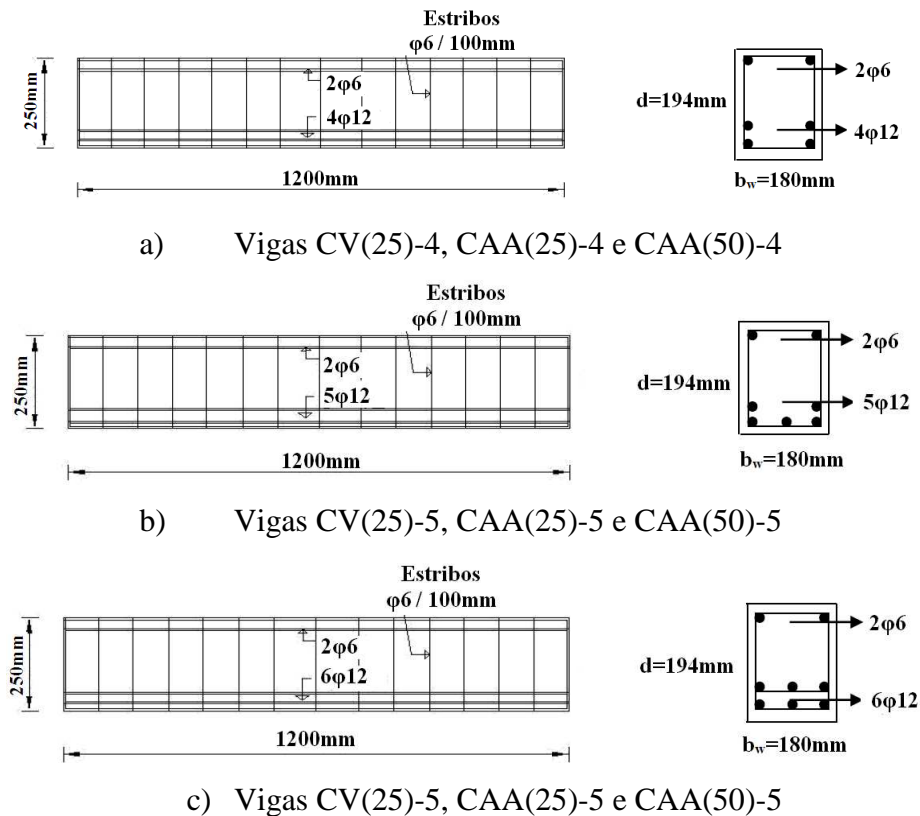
Dimensões e armaduras das vigas ensaiadas (SALMAN *et al.*, 2013, p.12).
